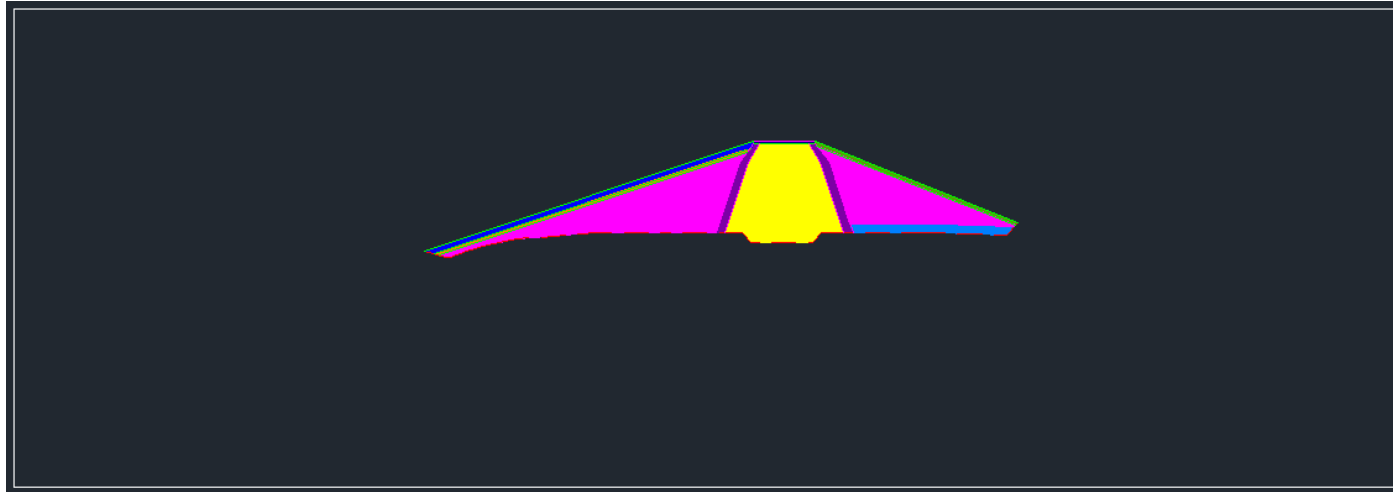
Metraj alan hesaplama – Kesit 3
